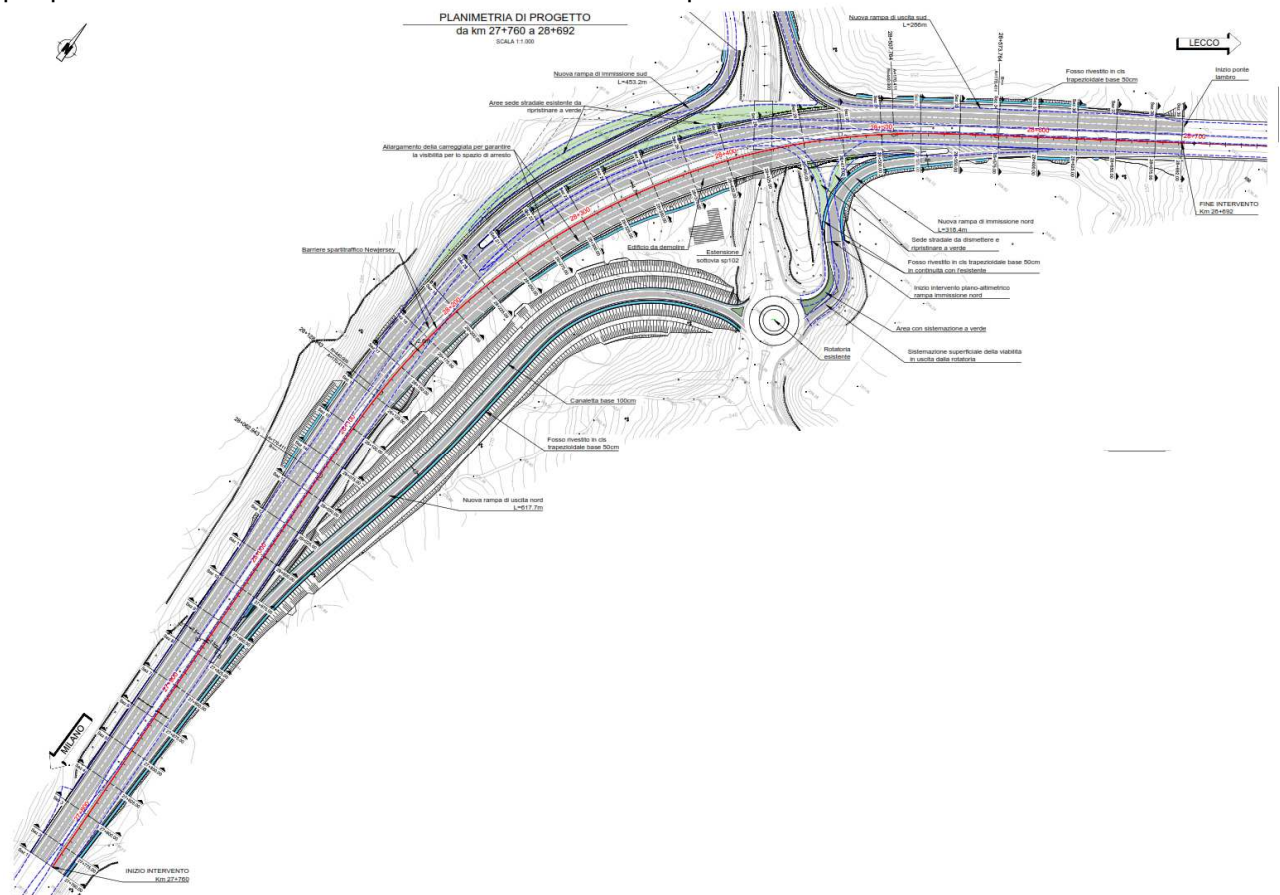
Planimetria di progetto svincolo Briosco - Arosio
